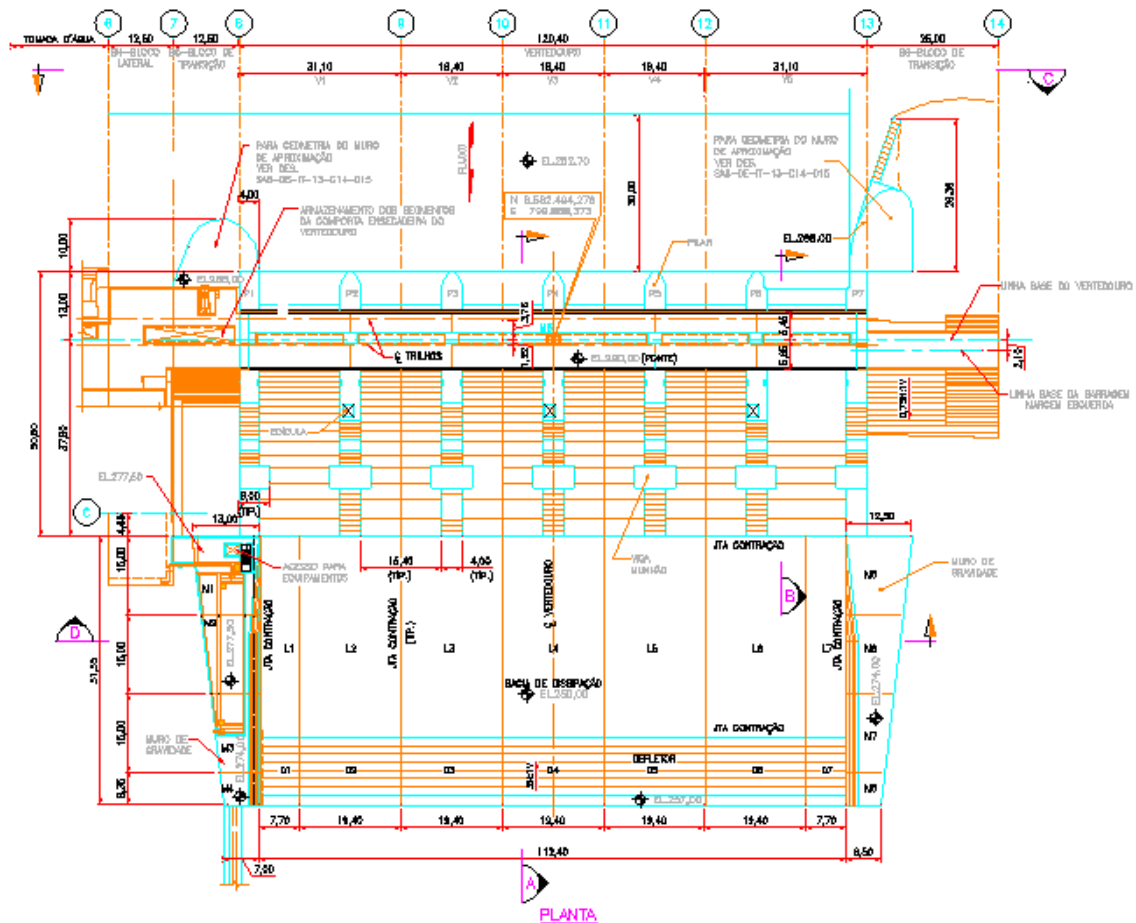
PLANTA VERTEDOURO UHE SÃO SALVADOR
